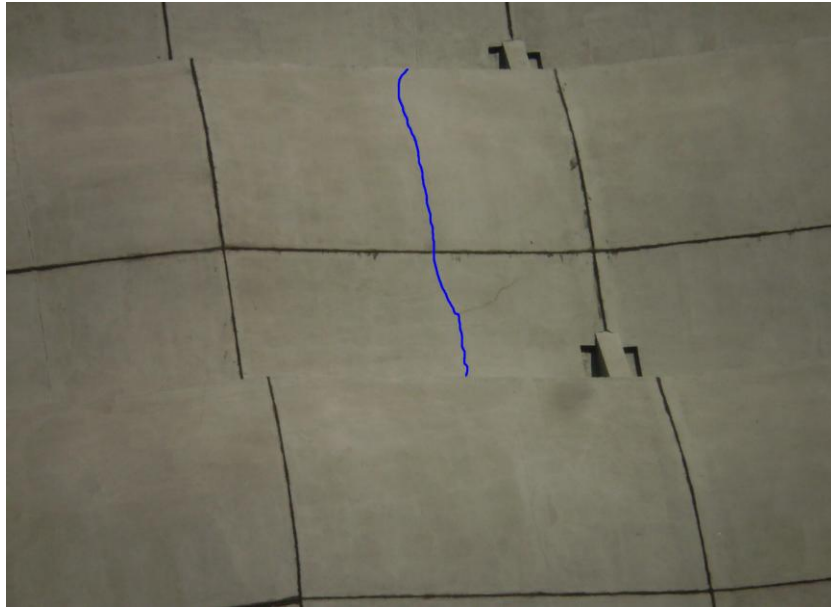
Fisura en el acabado de techo del Taller Galia.
